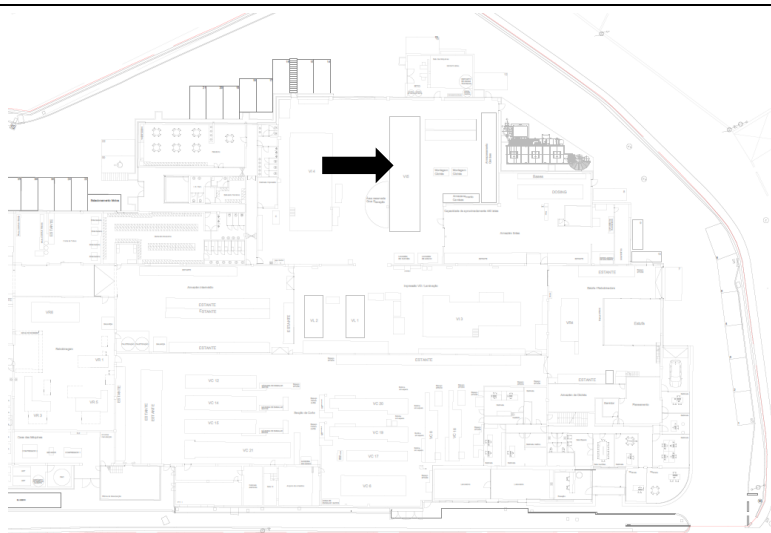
Planta do layout. (Fonte: Anexo XIX)
